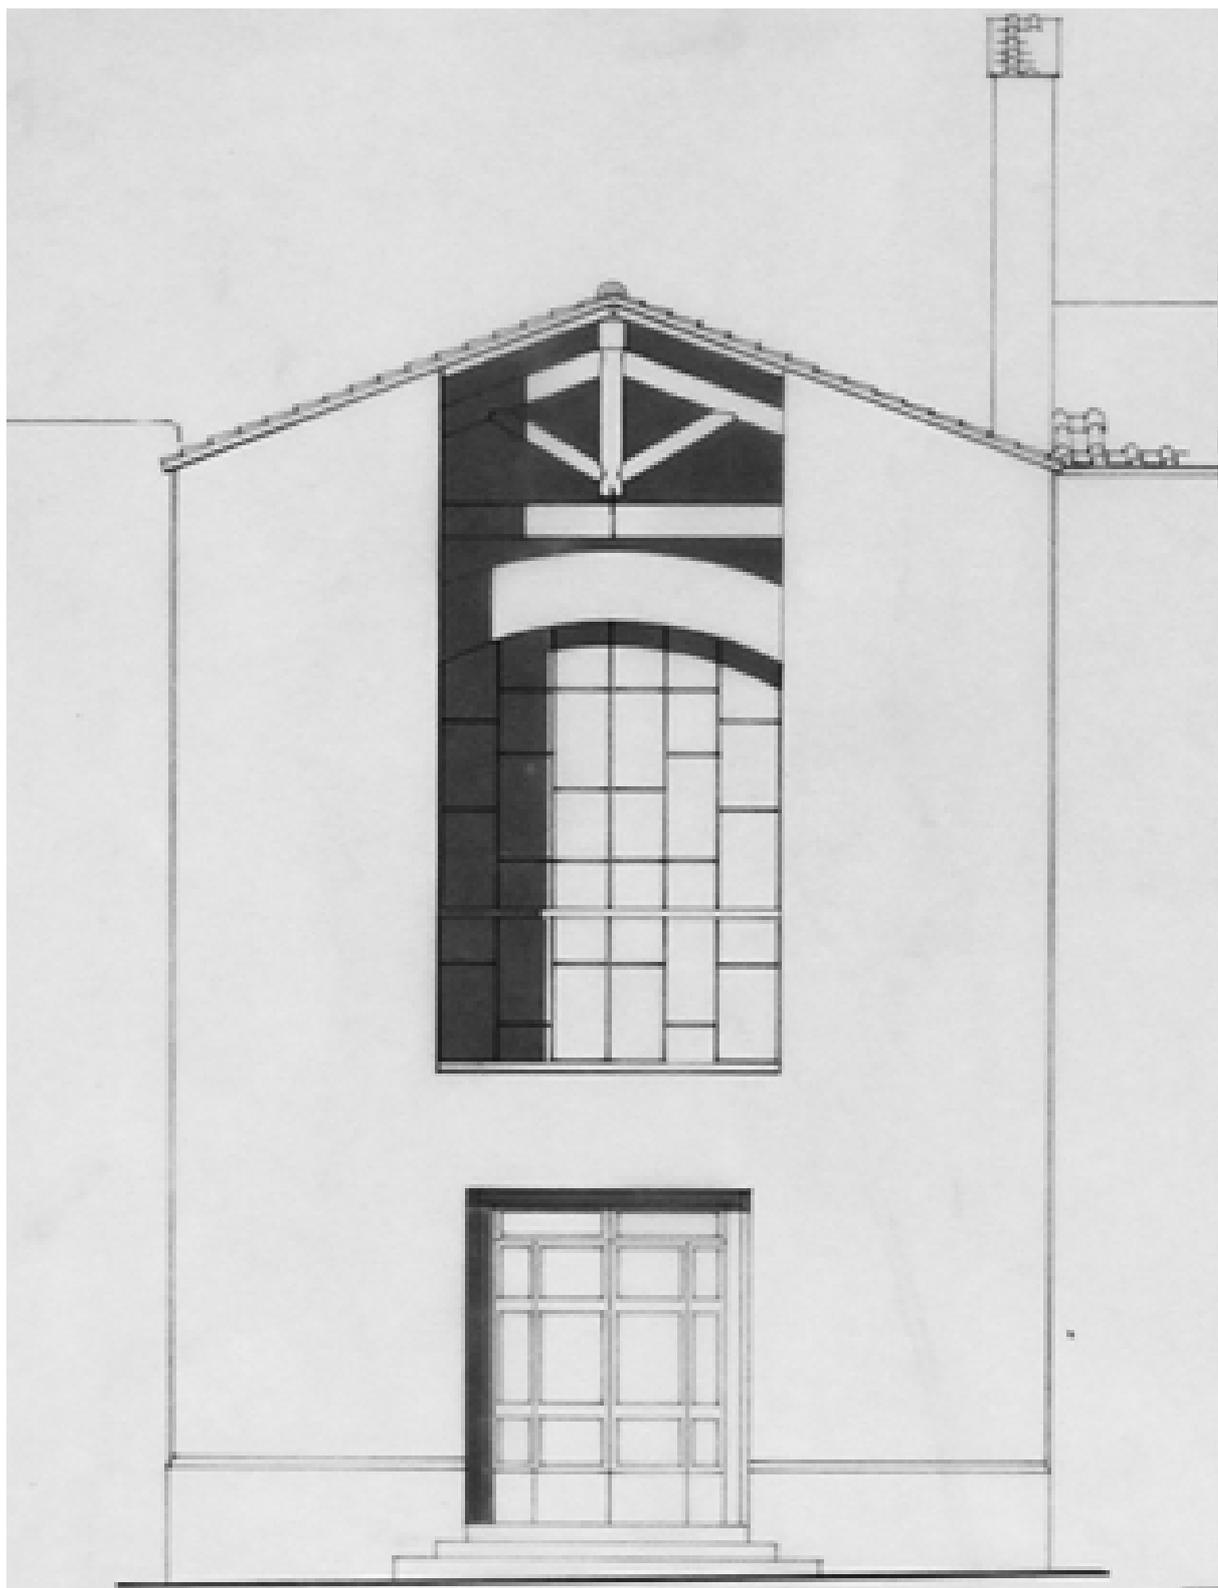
Prospetto Oratorio, lucido – s.d. (AABS-95.238)
